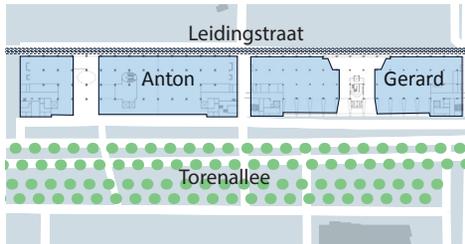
La planta baja se encuentra interrumpida en el edificio Anton y Gerard para comunicar la Calle Torenallee con el Leidingstraat. Elaboración propia.
